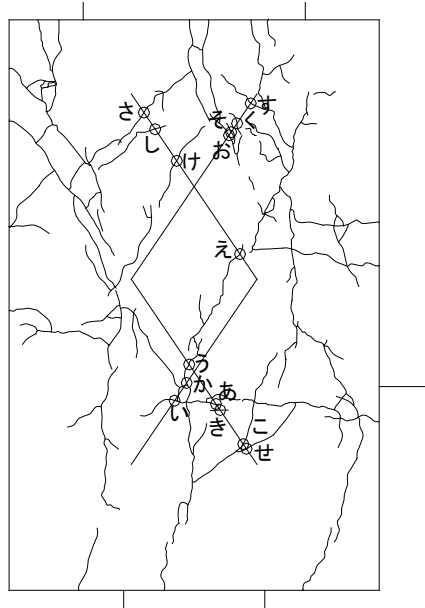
パイルキャップひび割れ幅測定位置 (試験体 A-5 負荷荷)
